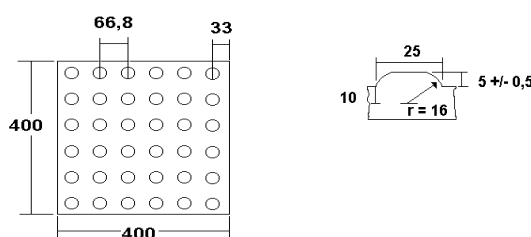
Planta e perfil do piso tátil de alerta (ACAPO (s.d.))
